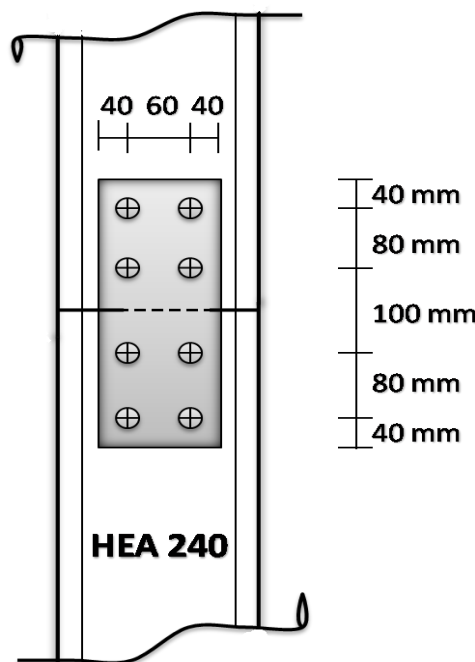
Assemblage poteau- poteau "couvre-joint de l'âme"
